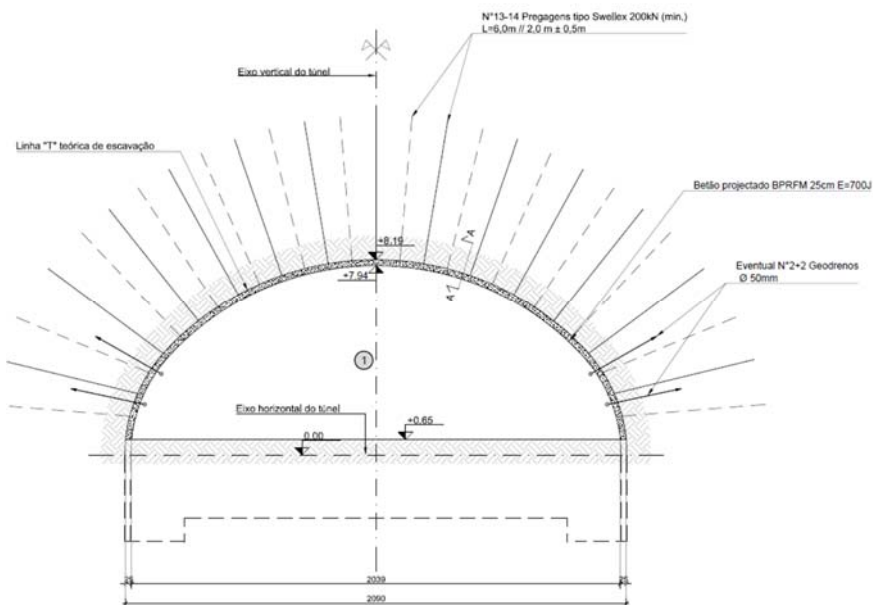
Secção tipo da fase 1 – escavação e suporte primário em ZG1
